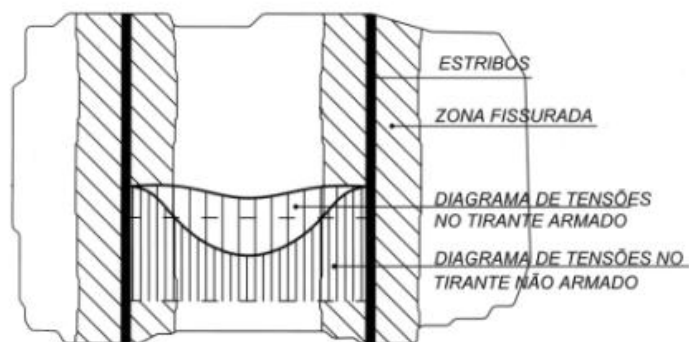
Diagramas de tensão nos tirantes de betão armado e não armado.
